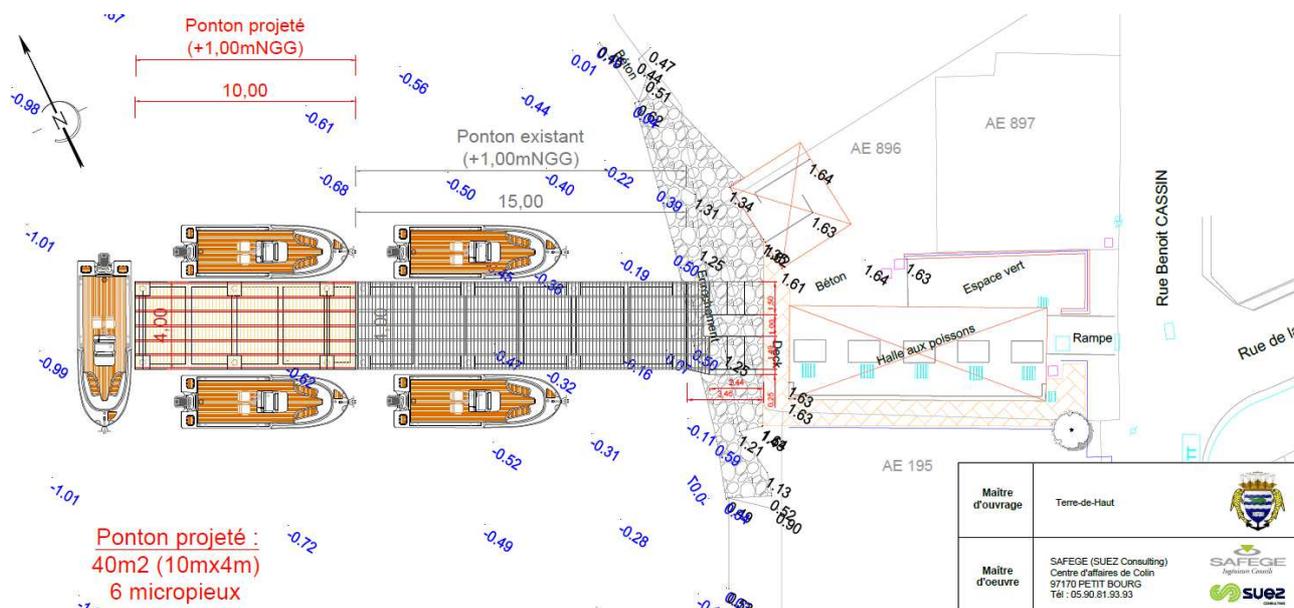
Plan de masse de l'aménagement (source : PRO/DCE Suez Consulting, décembre 2020)
